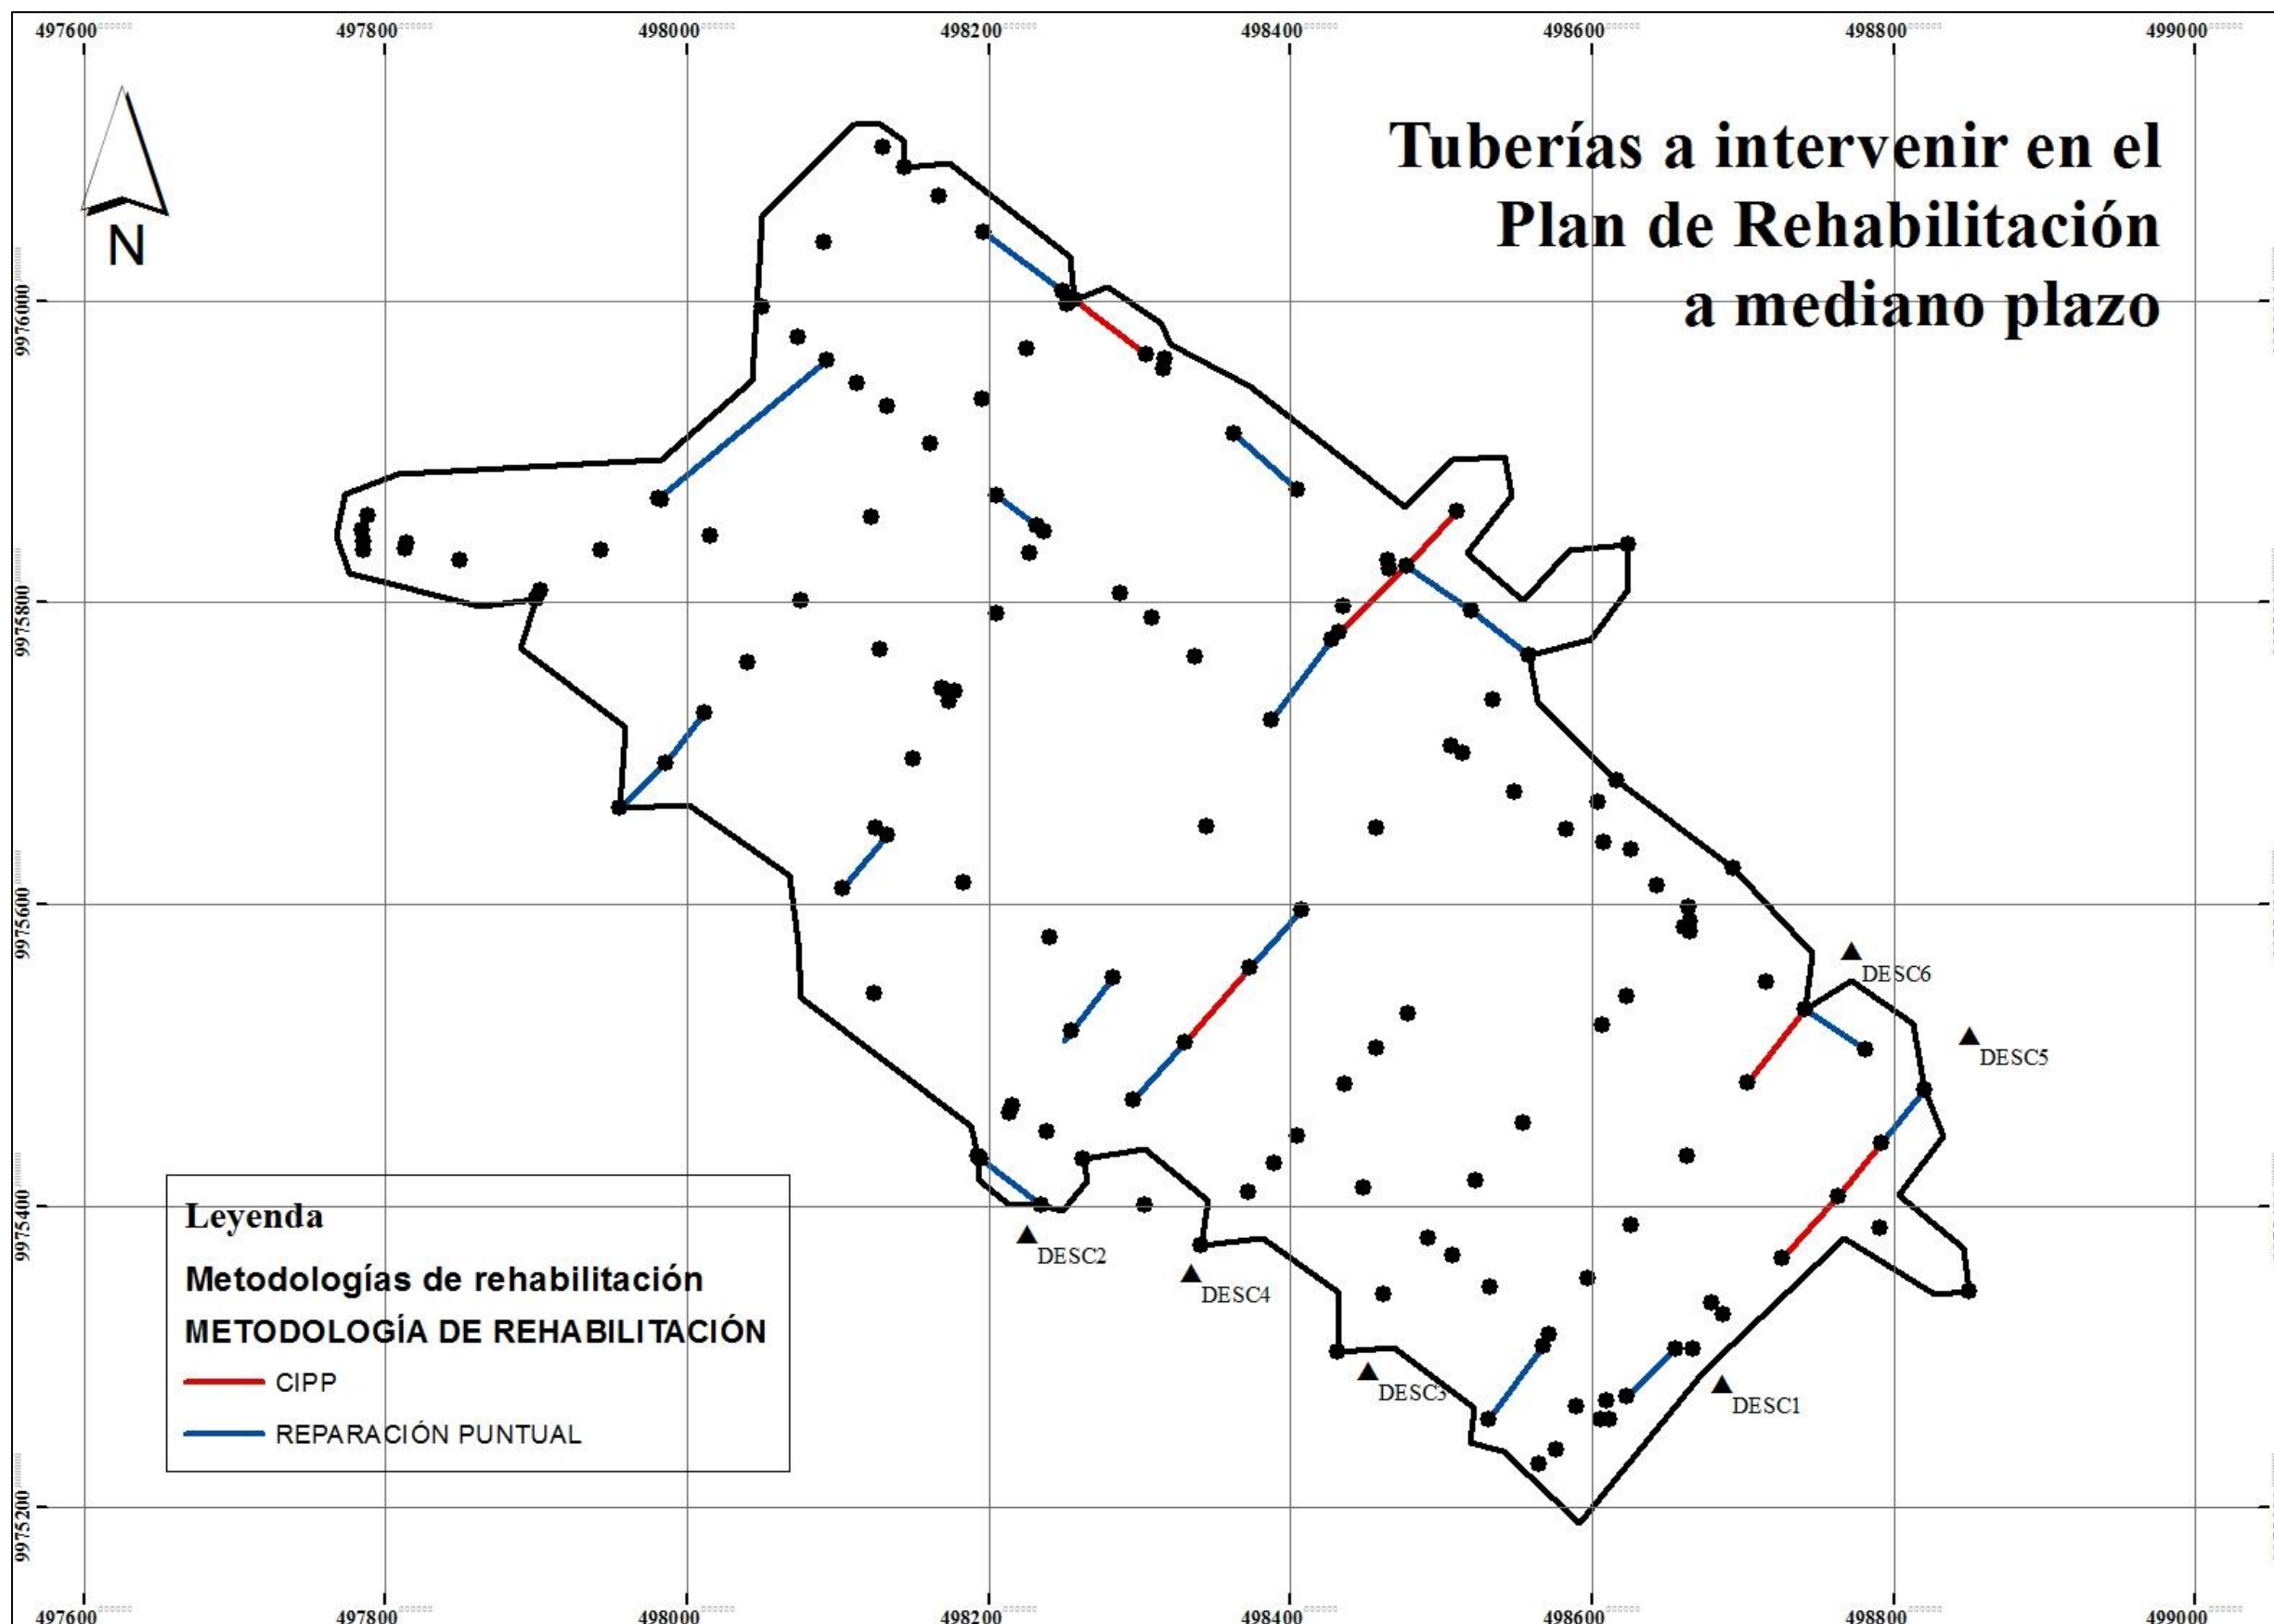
Tuberías a intervenir en el Plan de Rehabilitación a mediano plazo
